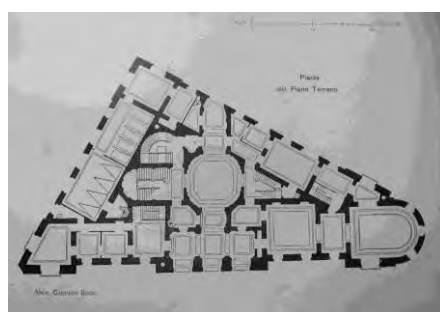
palazzo De Parente piazza Cavour pianta del pianterreno da "L'Edilizia Moderna", 1900
